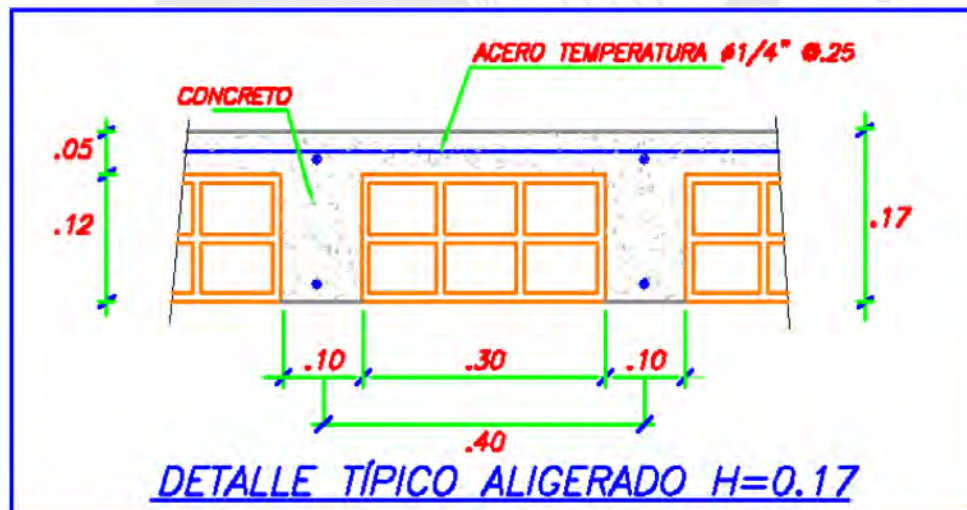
En la imagen se muestra la vigueta típica de una losa aligerada.
